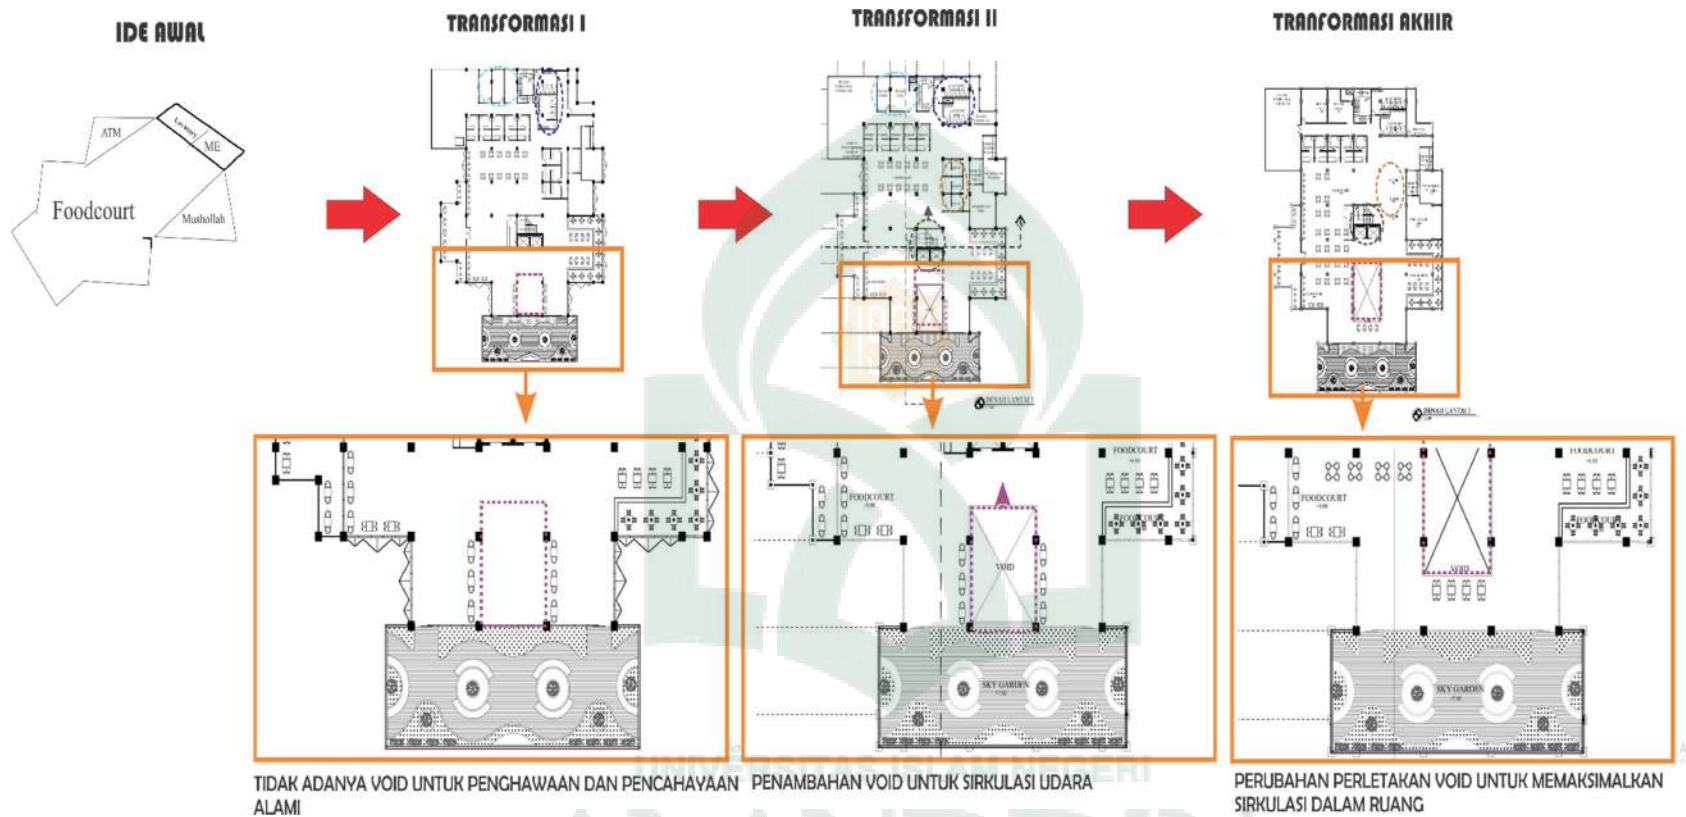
Transformasi Perletakan Layout Ruang Lantai 2 Perubahan 2
